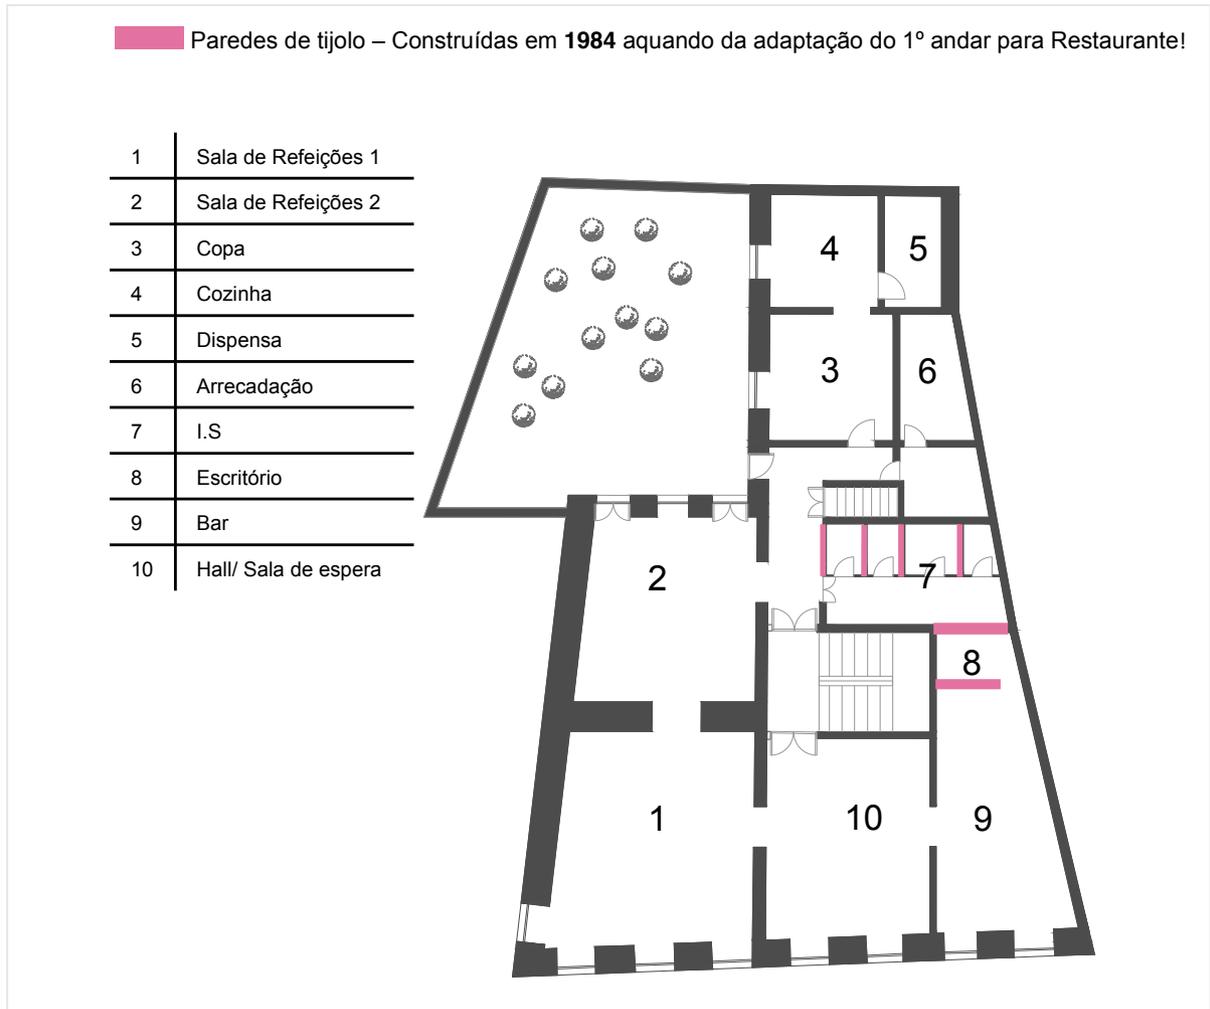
Planta piso 1 – Restaurante Solar Bragançano (Beatriz Ramos de Matos – desenhada em 2017 demonstração das alterações construtivas ao nível do interior do edifício).
